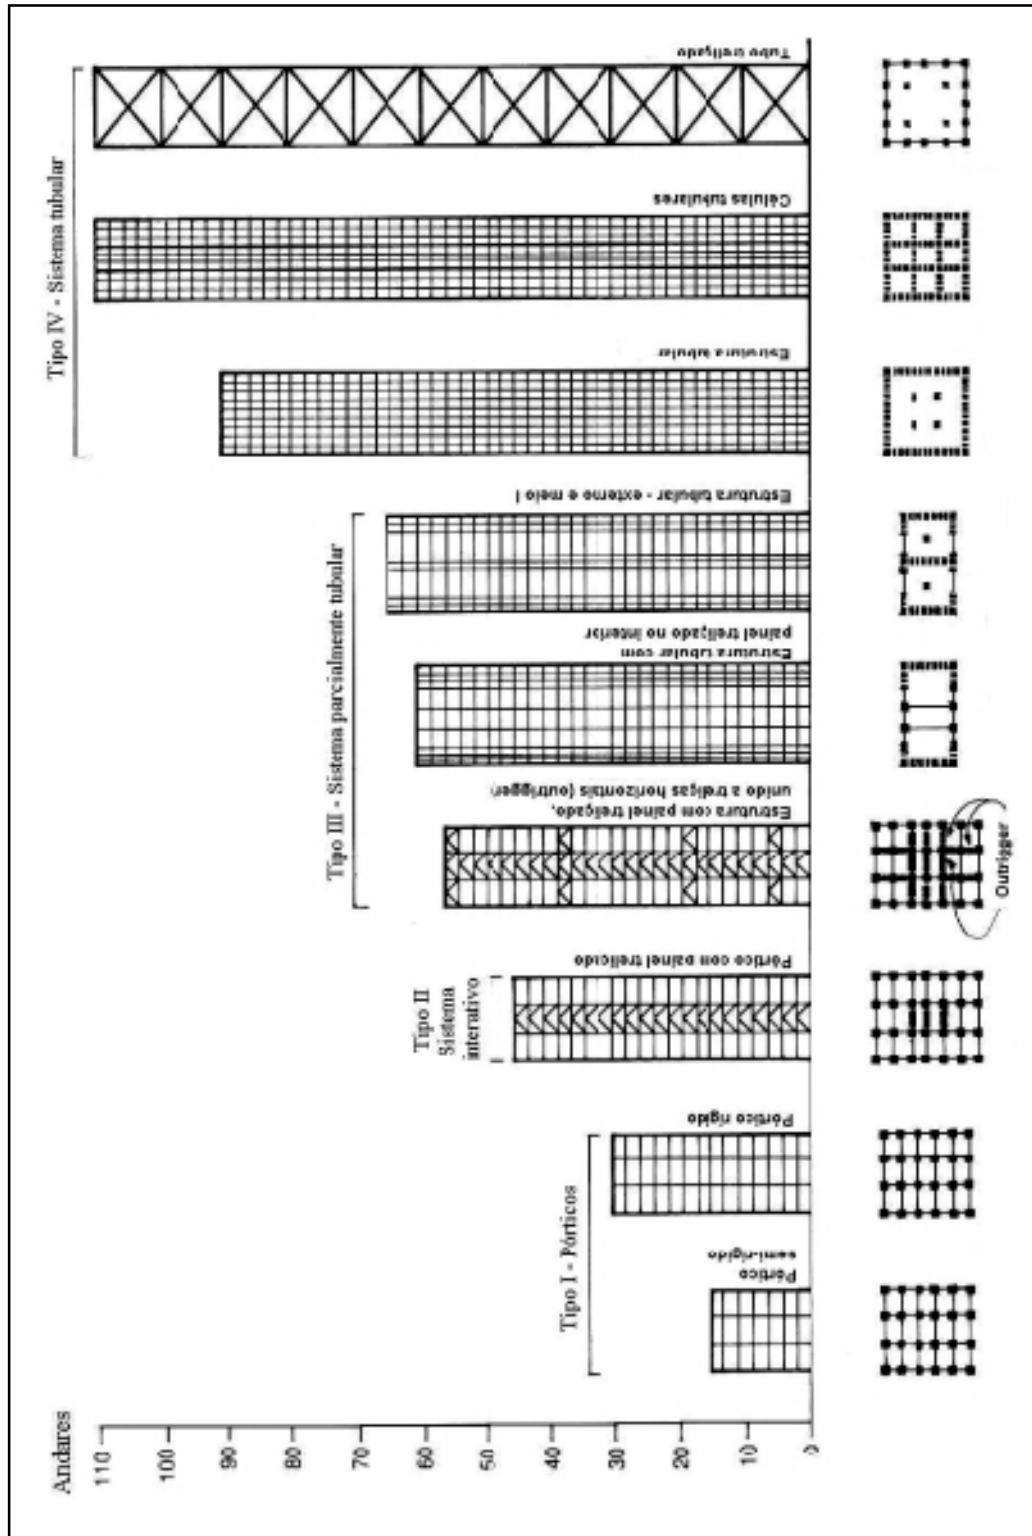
Sistemas de contraventamento para edificações estruturadas em aço [ref. 11]
